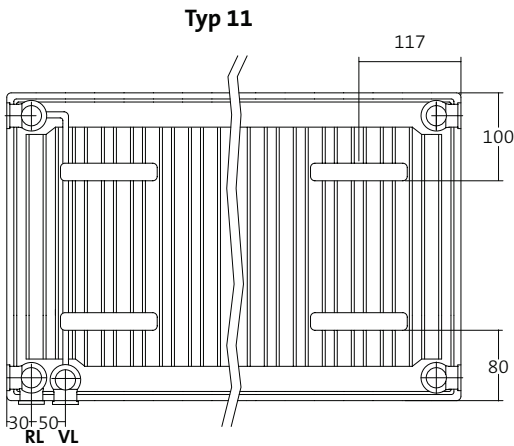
Laschenmaße für Ventil Compact Typ 11 mit Befestigungslaschen (Rückansicht)
